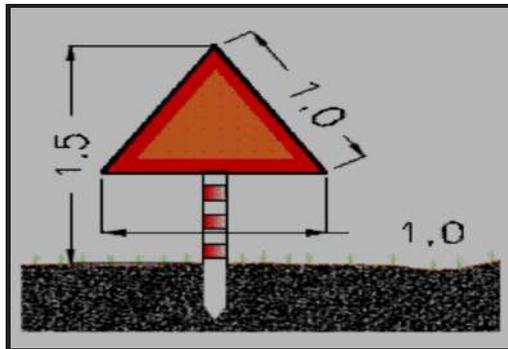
DETALLE DE LAS BALIZAS DE FINAL DE PISTAS NO PAVIMENTADAS
